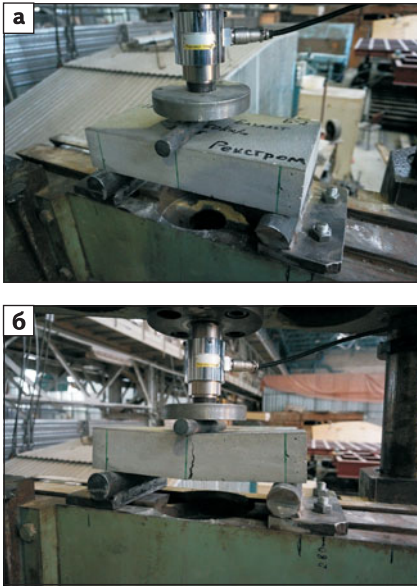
Опытные образцы бетонной плиты, армированной композитной сеткой, до (а) и после (б) испытаний на изгиб
